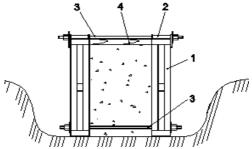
Схема опалубки ленточного фундамента 1 — щит; 2 — съемный упор тяжа; 3 — винтовой тяж; 4 — деревянная распорка
